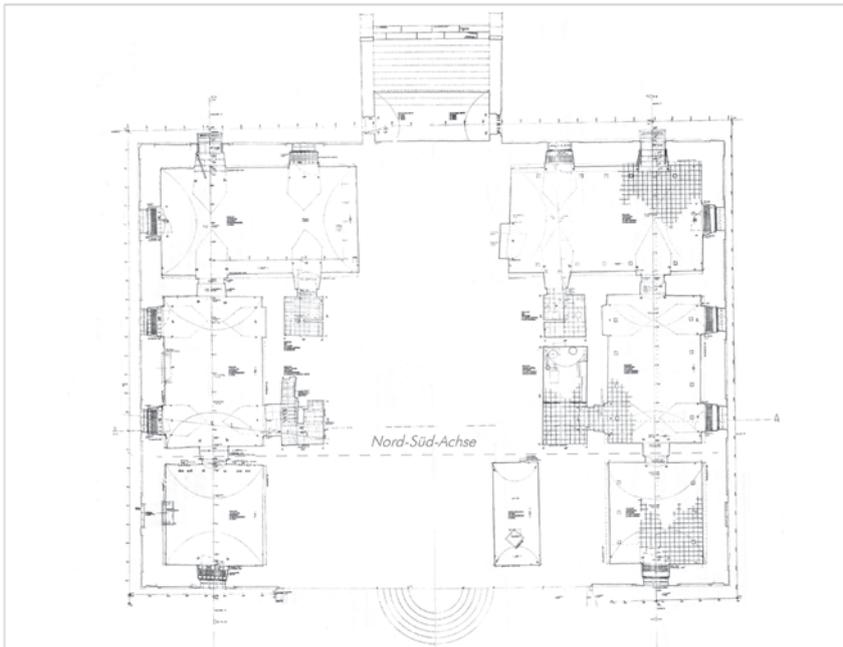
Grundriss Sockelgeschoss (o. M.), Fuchs, Pieritz, Winter, August 2004
